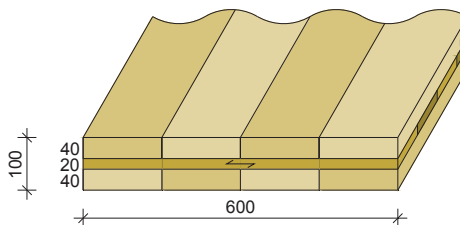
Querschnittsabmessungen und Lagenaufbau der Prüfkörper zur Ermittlung der Biegefestigkeit von geraden Brettsperrholzträgern mit und ohne Universal-Keilzinkenverbindung
